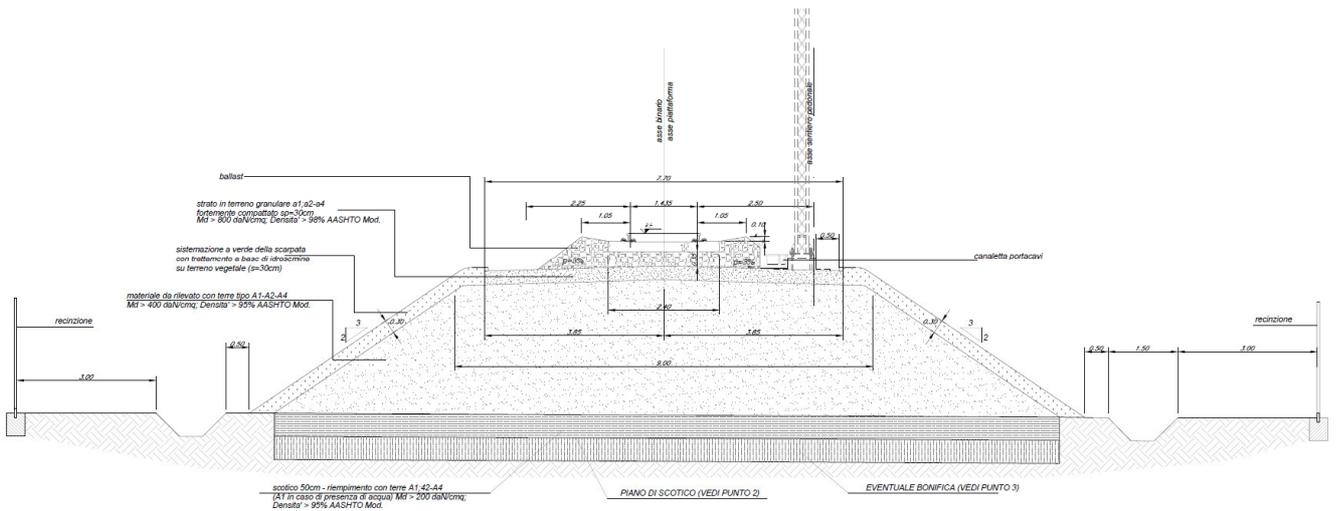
Sezione tipo in rilevato Variante Provvisoria alla Linea Storica
